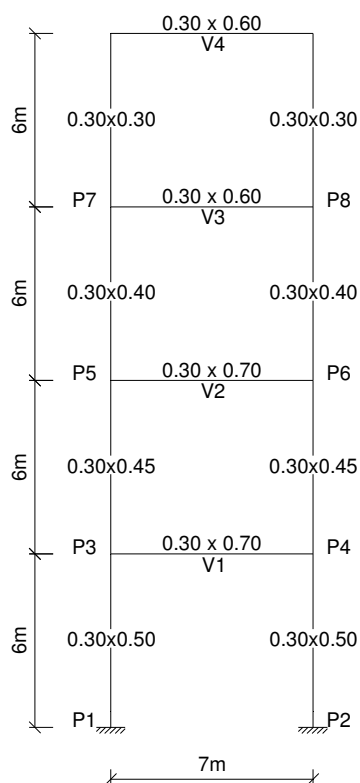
Dimensões das secções e configuração geométrica do pórtico PT41
